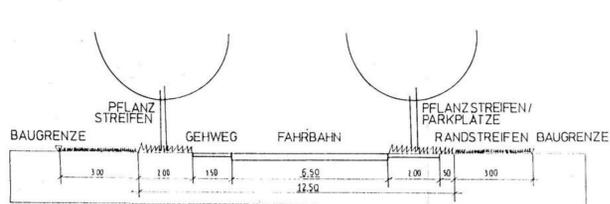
DETAIL VERKEHRSDÄMPFUNG G M.: 1:200
